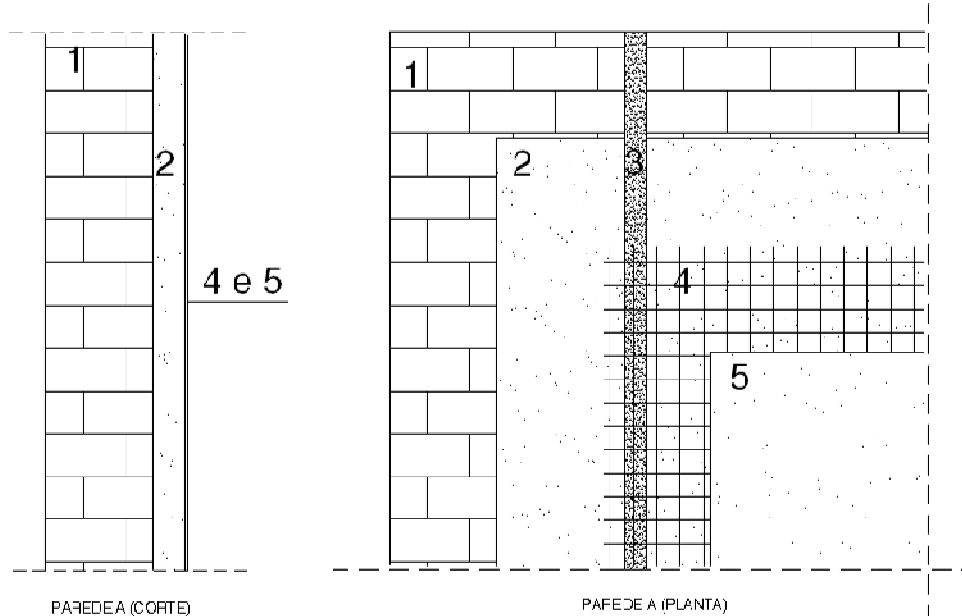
Esquema demonstrativo da constituição do provete (Parede A em corte e planta).
